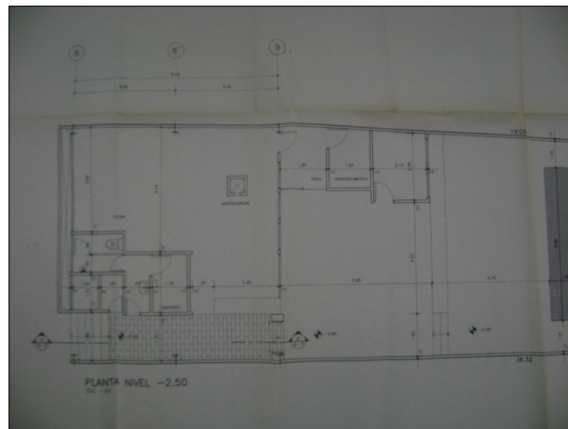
Fotografía de Plano de Arquitectura de Sótano
